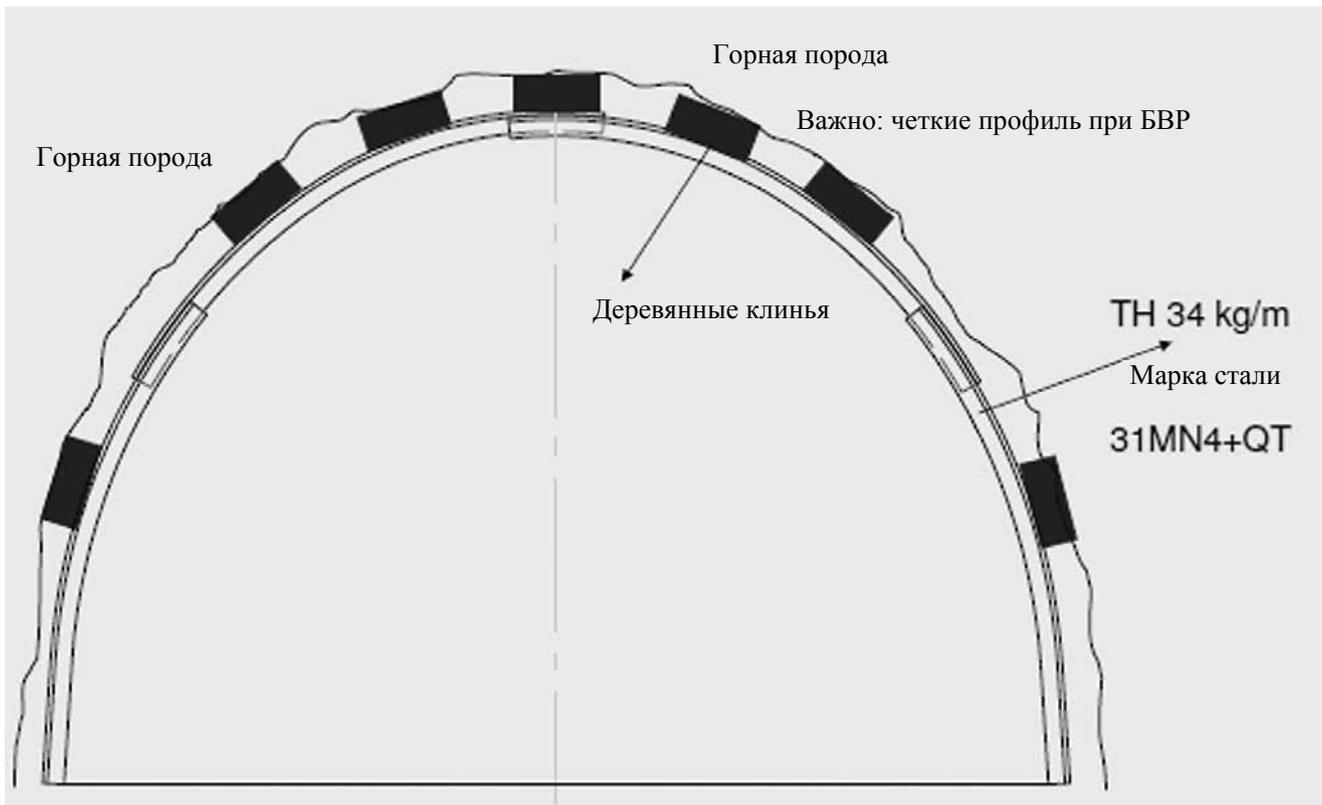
Схема сечения арочной крепи с закреплением деревянными клиньями
